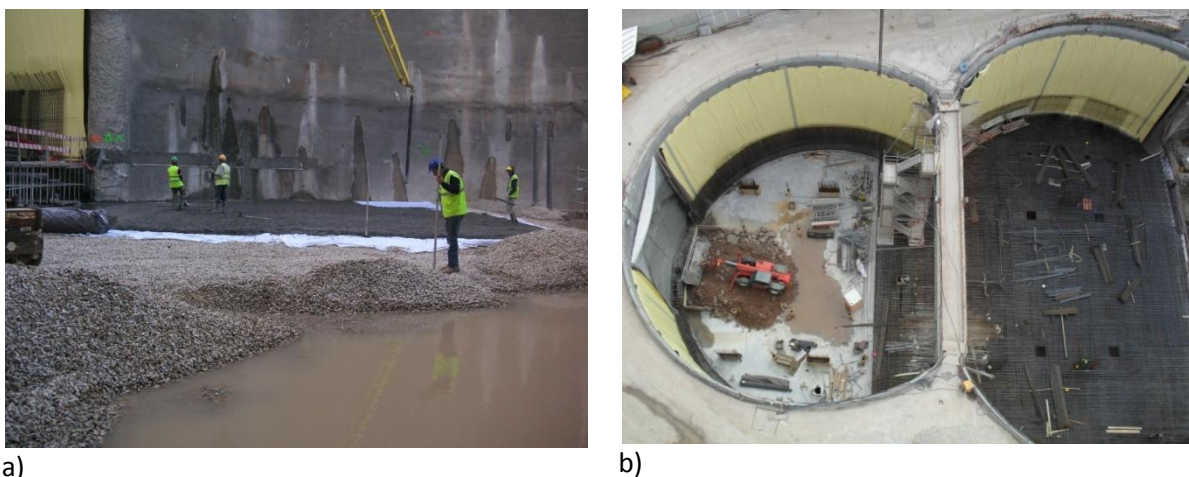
a) Execução de pregagens tipo swellex e execução de geodrenos; b) Plano aéreo da laje betonada do poço 1 e impermeabilização do poço 1 e 2.
